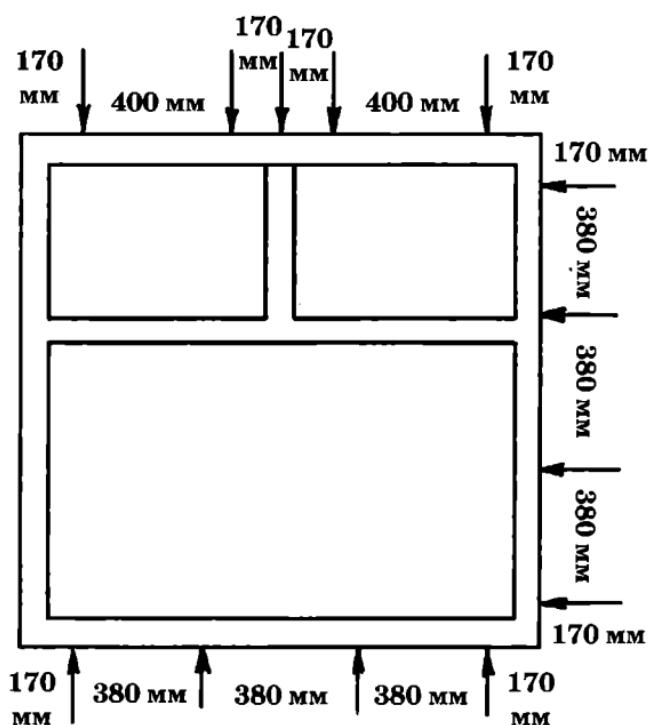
Схема размещения крепежных элементов при монтаже окна из ПВХ-профиля
